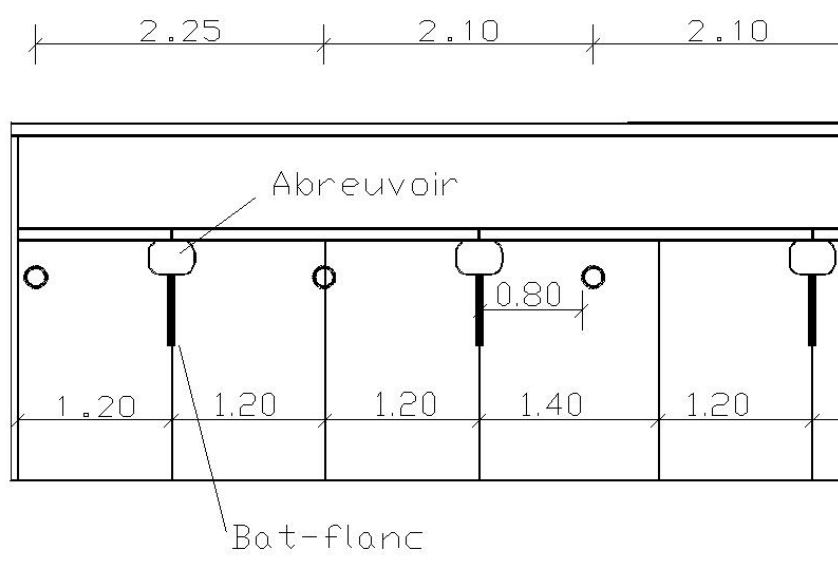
Plan montrant un pilier de soutènement situé dans le secteur réservé aux animaux
